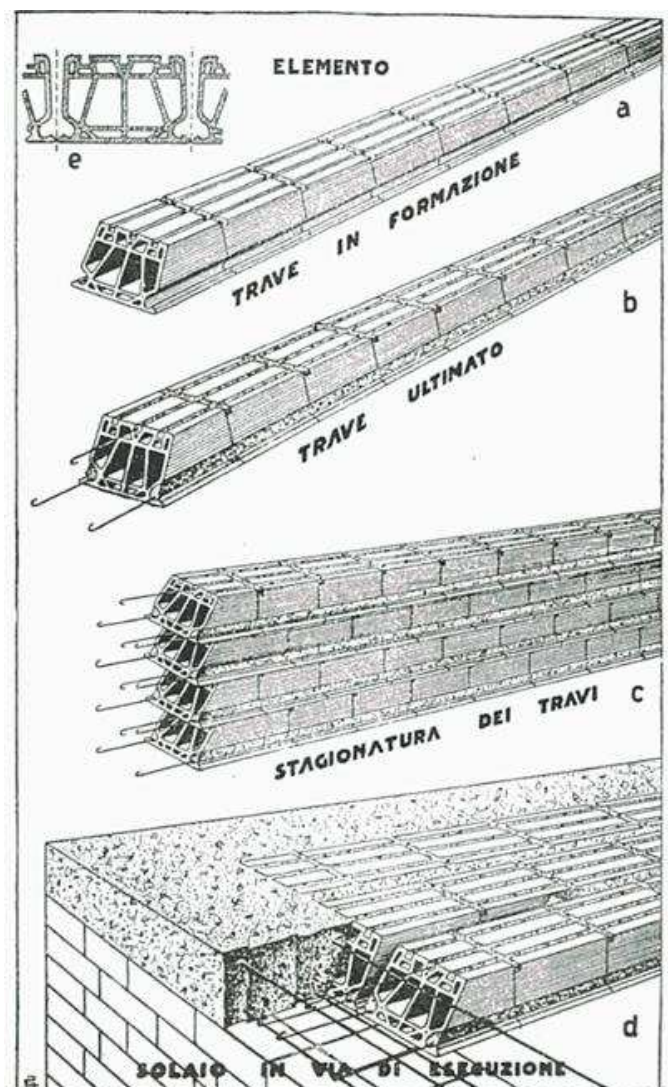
elementi costituenti il solaio *SAP* e particolari costruttivi. Osserviamo in *a* un travetto in costruzione con la disposizione degli elementi laterizi; in *b* il travetto ultimato con l'aggiunta dell'armatura e del getto di calcestruzzo ad alta resistenza; in *c* la stagionatura delle travi; in *d* il solaio durante la fase di esecuzione; in *e* l'elemento laterizio singolo (da Astrua G., *Manuale completo del capomastro assistente edile*, Hoepli Editore, Milano 1995).
